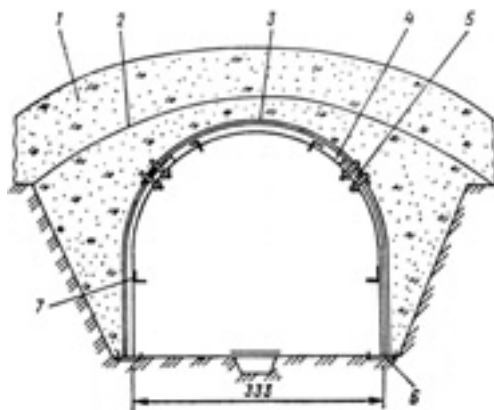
Быстровозводимое убежище из арочной податливой крепи: 1 – насыпной грунт; 2 – гидроизоляция; 3 – техническая ткань по металлической сетке; 4 – крепь АР-3 (СВП-22); 5 – узел податливости; 6 – швеллер № 20; 7 – уголок 50х50
